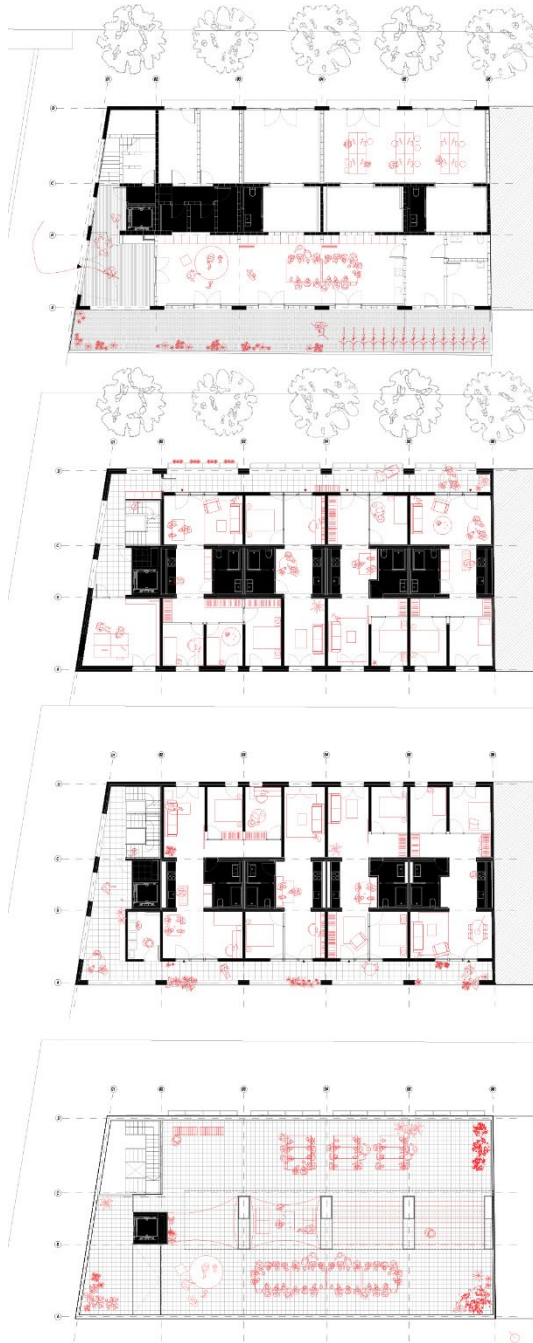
Plantas del proyecto de vivienda cooperativa La Balma.
